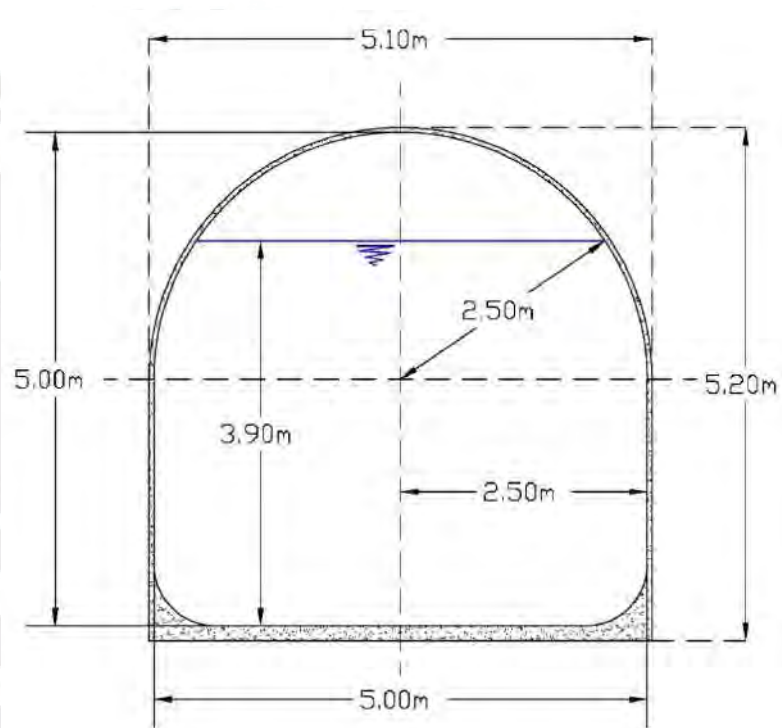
Sección típica de túnel. Fuente: Elaboración propia.
